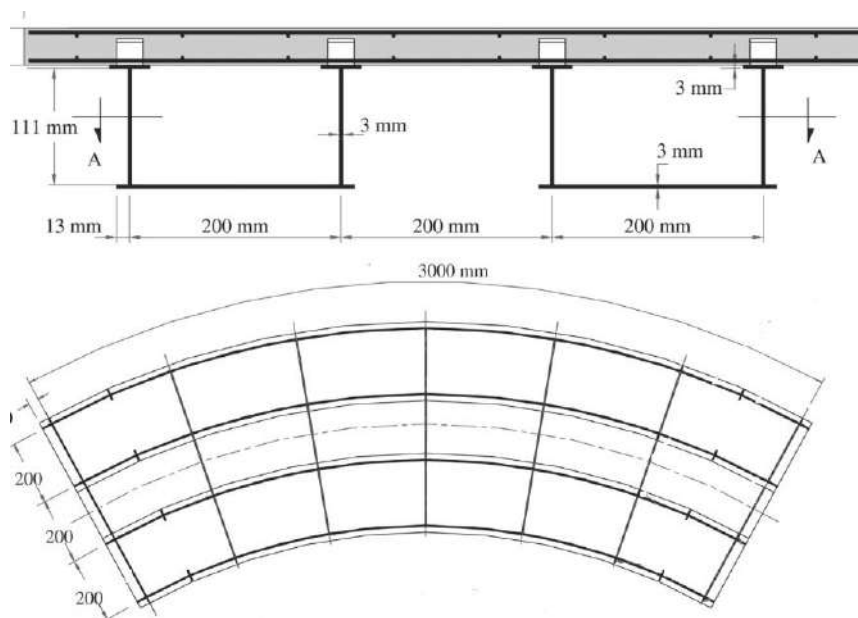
Aplicação da seção tipo caixão em pontes, seção transversal e planta (Fonte: ANDROUS *et al.*, 2017 - Adaptado).
